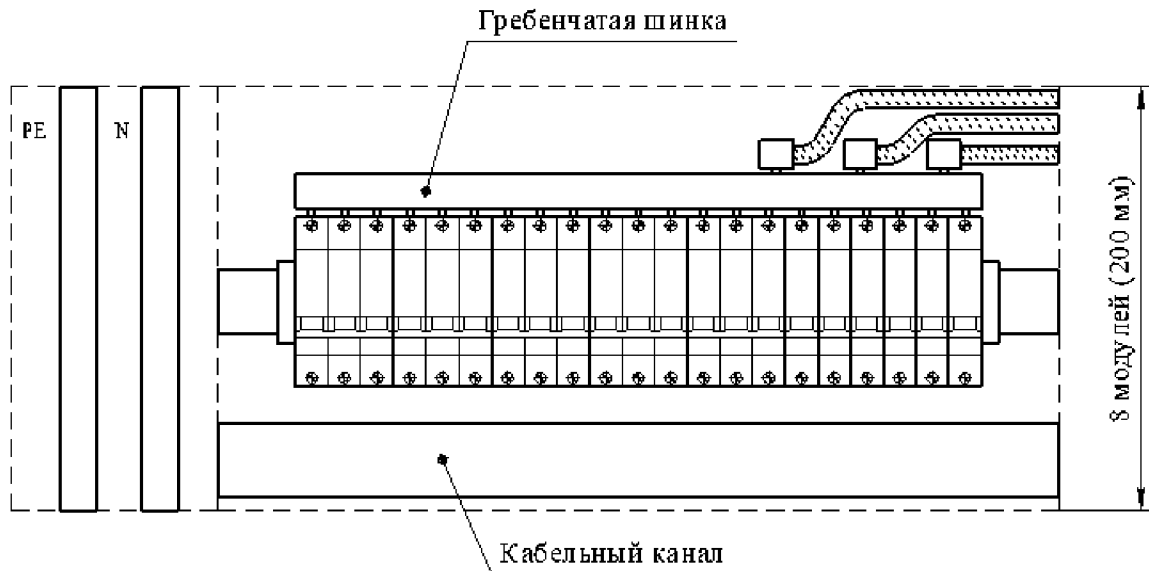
Блок с выключателями, установленными на DIN-рейке
